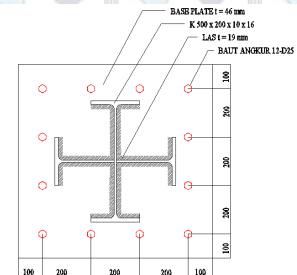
Sambungan Kolom dan Kolom Lantai 2
